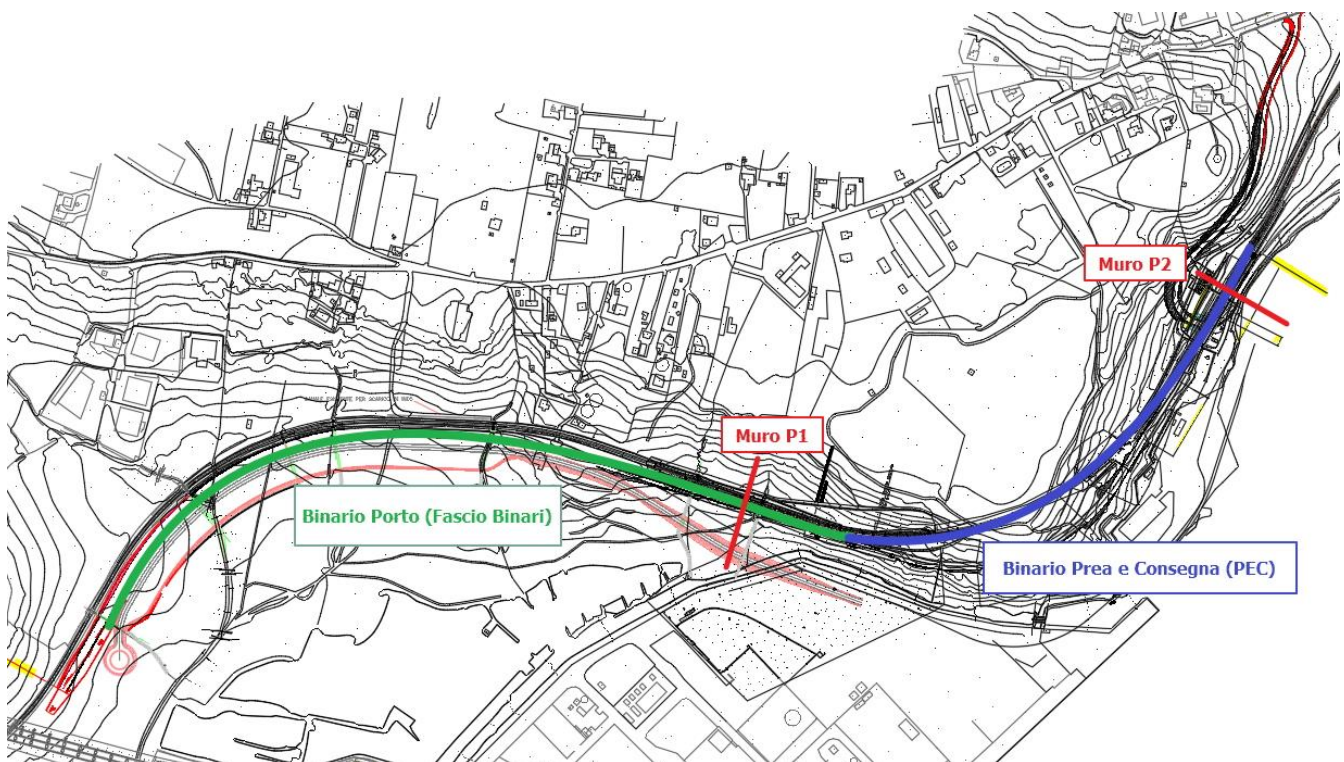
Pianta delle sezioni tipologiche individuate
